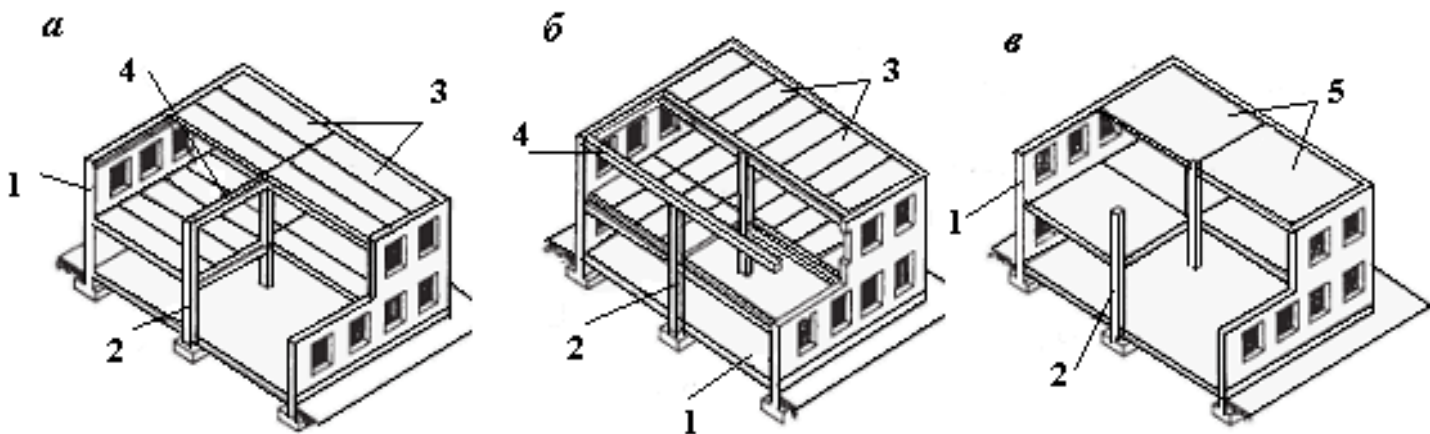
Конструктивні схеми будівель з неповним каркасом: а – з поздовжнім розташуванням ригелів; б – з поперечним розташуванням ригелів; в – безригельні. 1 – зовнішні стіни; 2 – колони; 3 – міжповерхові плити перекриття; 4 – ригелі; 5 – плити перекриття
